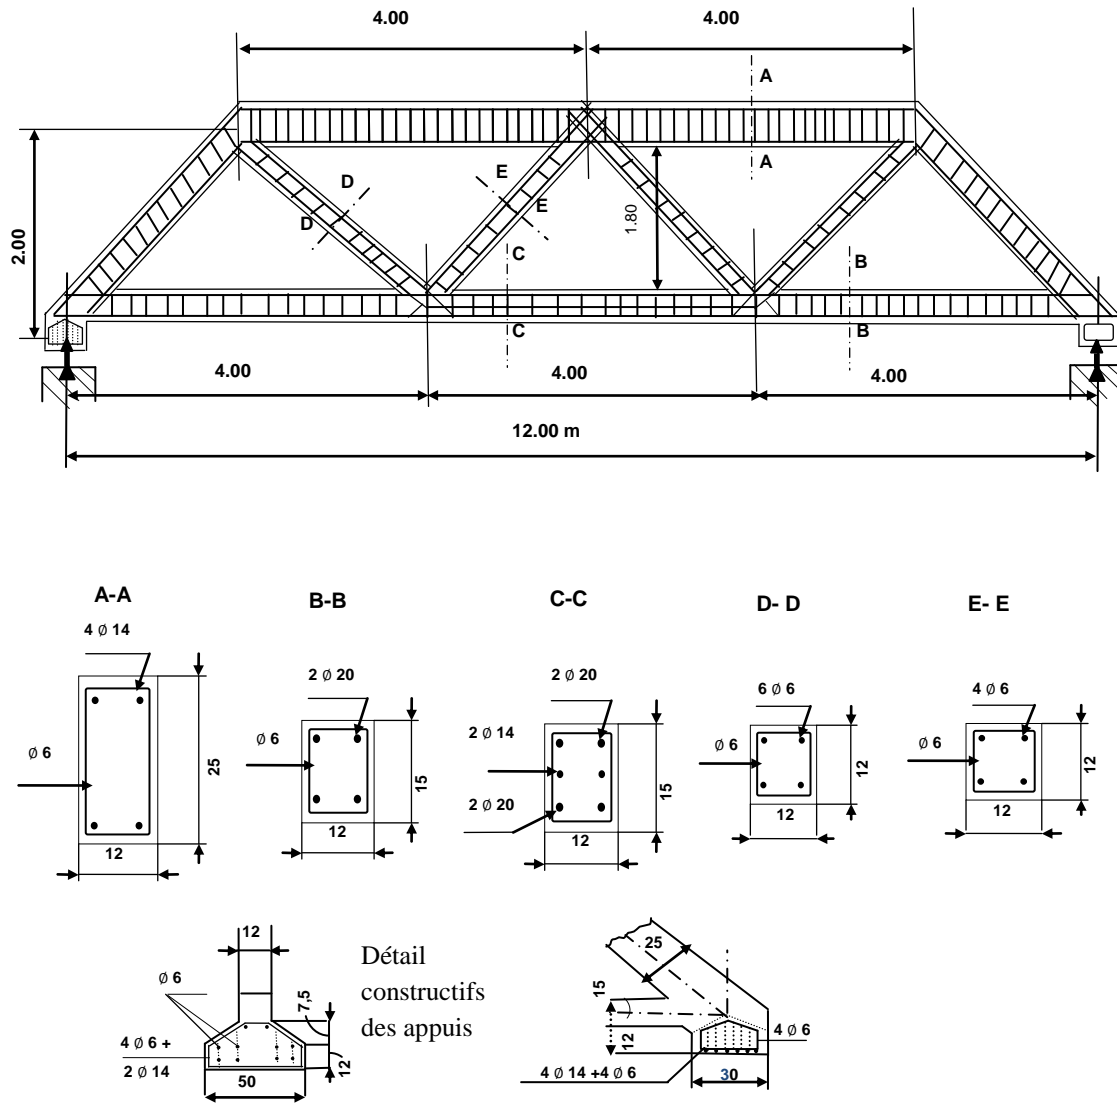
Détails constructifs de la poutre triangulaire d'épreuve
